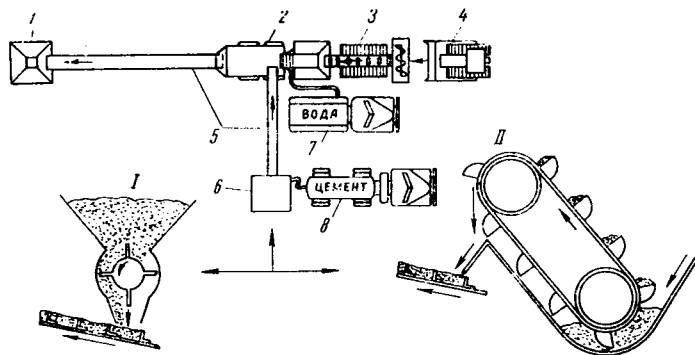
Схема размещения машин и смесителя Д-370 в карьере: I — роторный дозатор (ячейковый); II — ковшовый дозатор; 1 — накопительный бункер; 2 — смеситель Д-370; 3 — погрузчик Д-415; 4 — бульдозер; 5 — транспортер; 6 — дозатор цемента; 7 — поливомоечная машина; 8 — автоцементовоз
